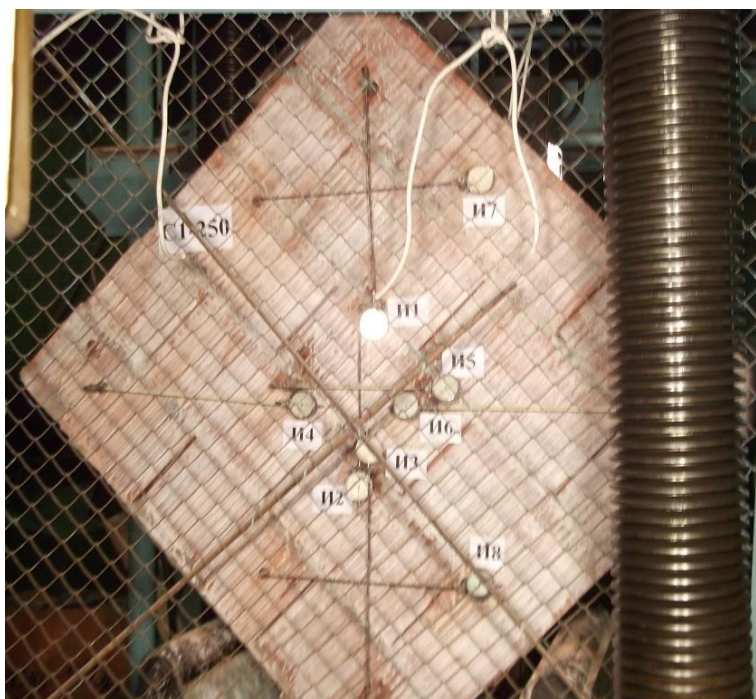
Образец из крупноформатного керамического камня в прессе
